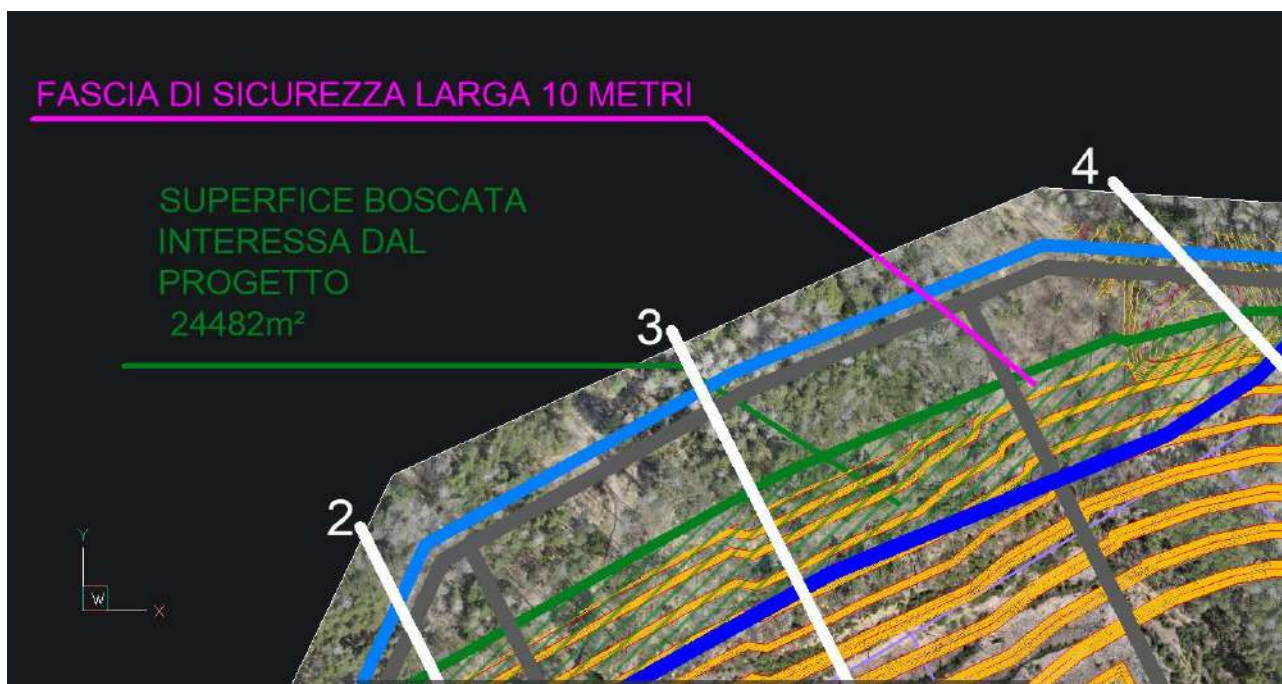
Rappresentazione planimetrica della superficie boscata che sarà interessata dalla attività escavativa nell'area di ampliamento
